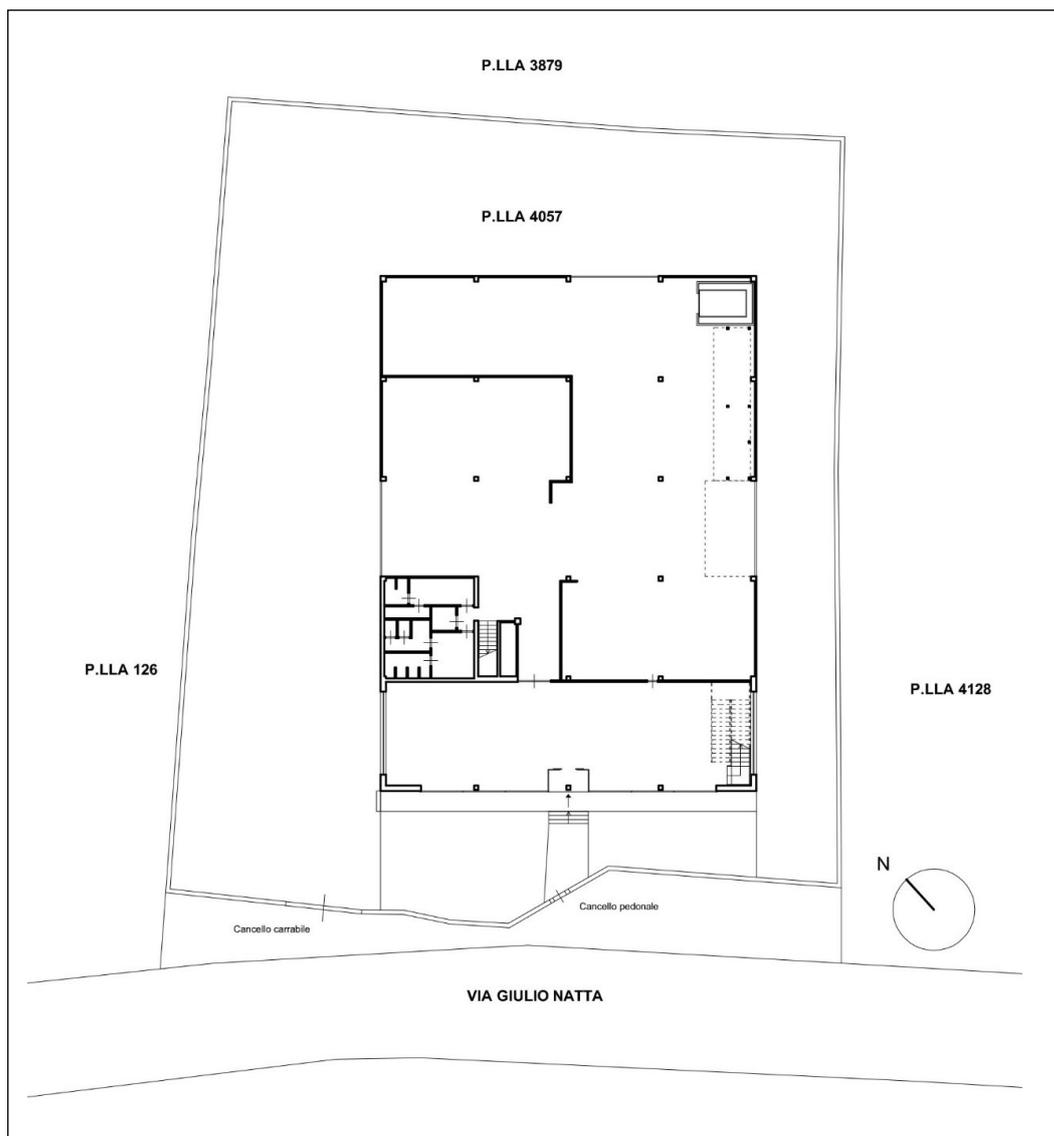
Rilievo del piano terra dell'immobile pignorato con lotto di terreno.
